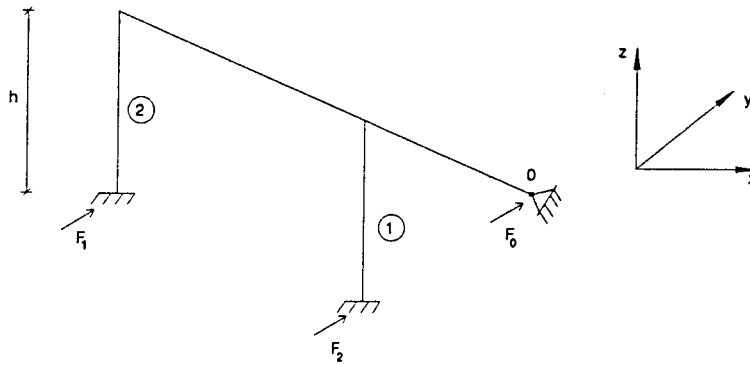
Pórtico com 1 andar e 2 pilares e com apoio duplo no plano horizontal.
